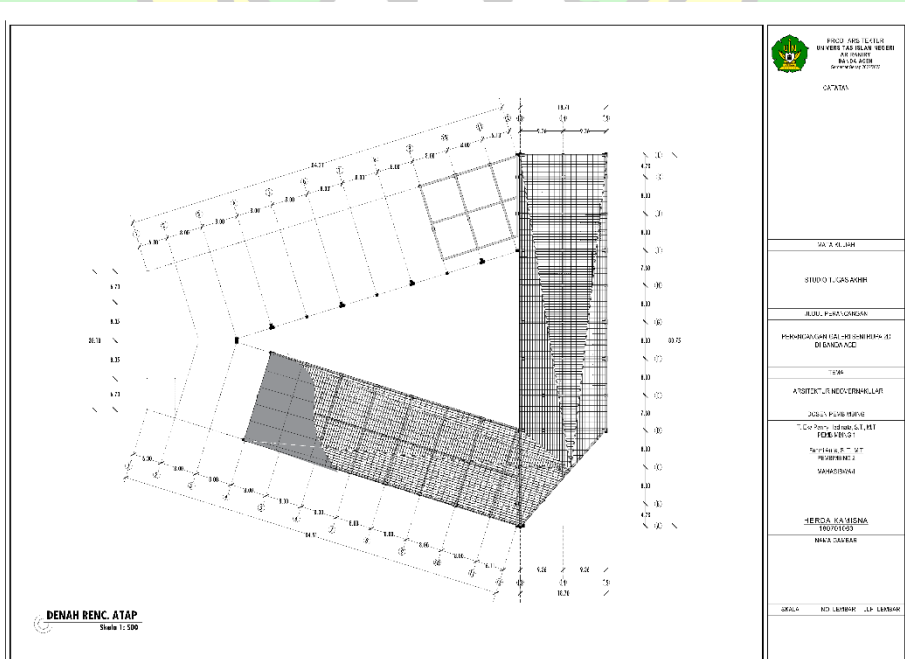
60 Denah Rencana Dak Elv. +18.00
